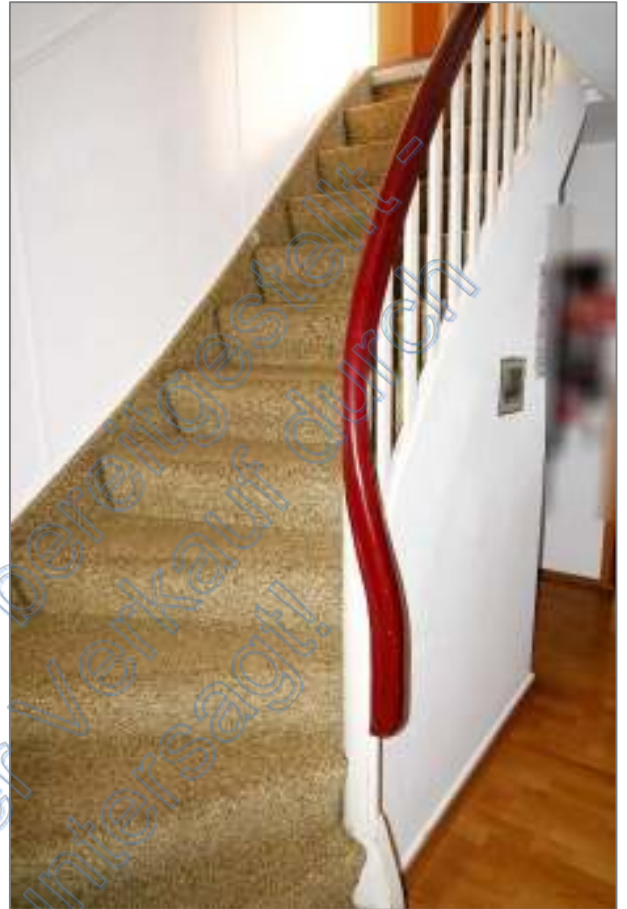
Wohnhaus - Flur EG mit Treppe zum DG
